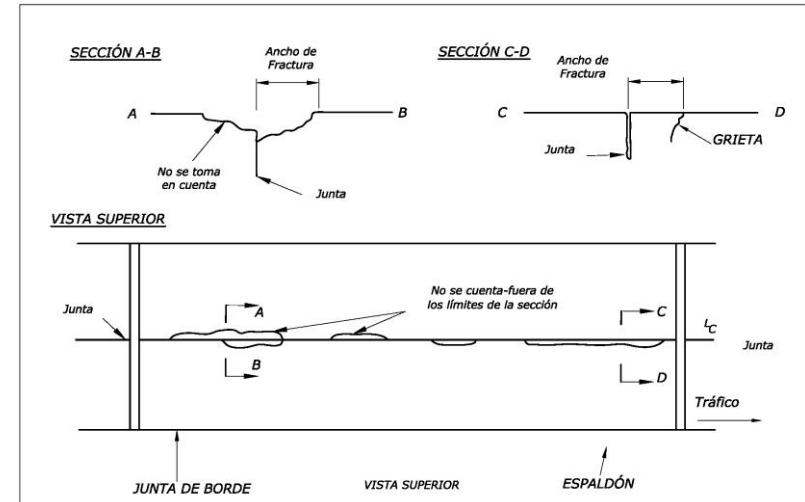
Esquema Fractura de Junta - Pavimento Rígido
